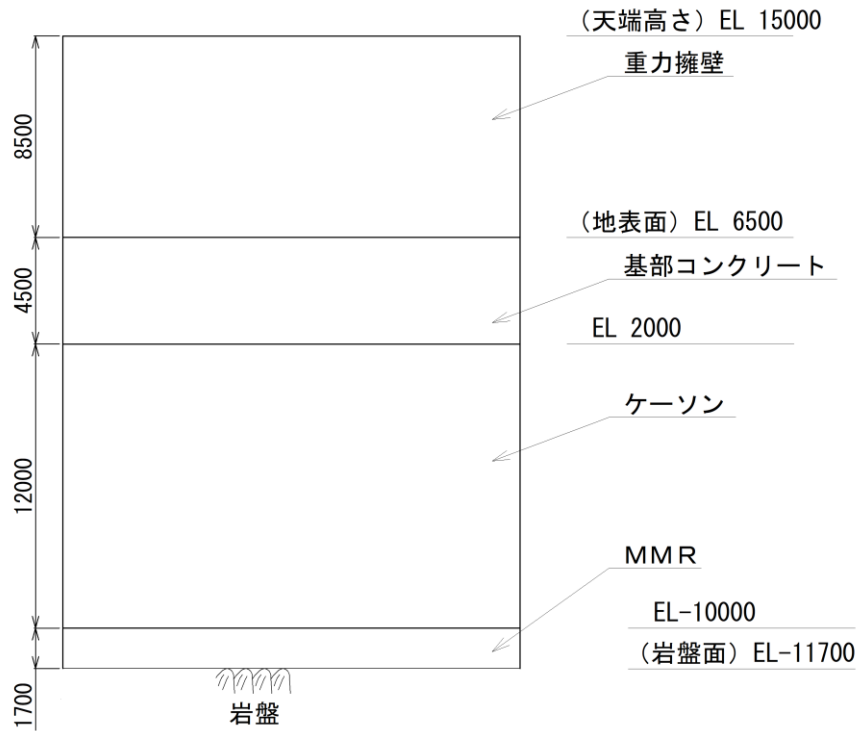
(1) 防波壁（波返重力擁壁）の構造図（正面図）（ケーソン設置部）
